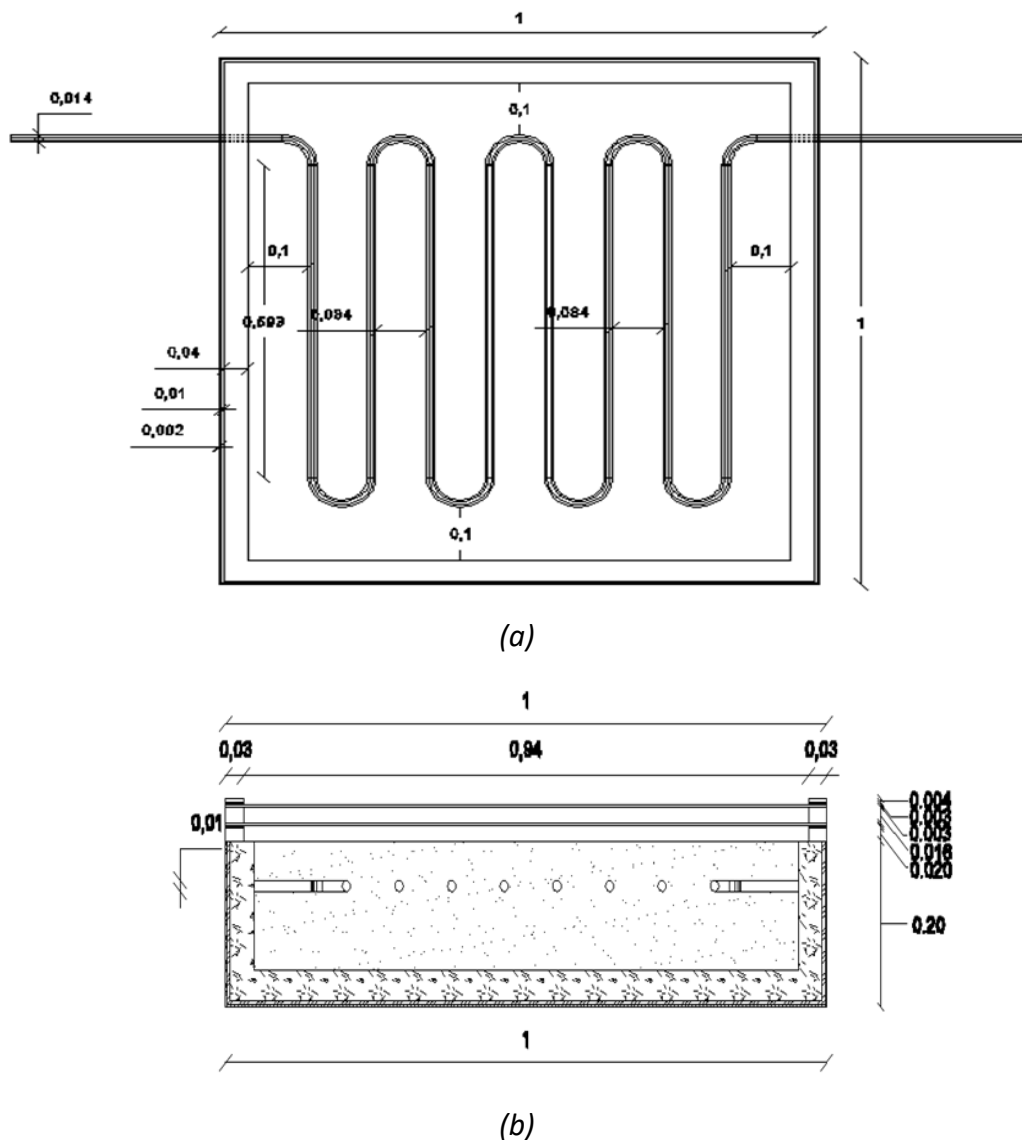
Schéma dimensionnel du CSTPSSI :a) coupe transversale et b) coupe longitudinale
